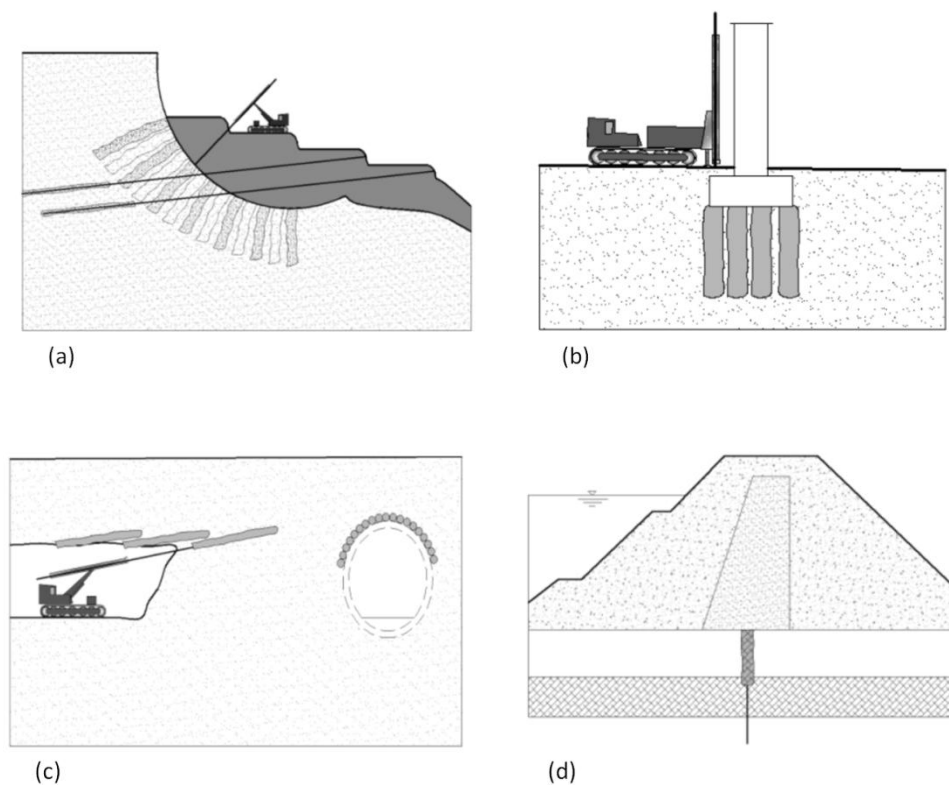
Utilização da técnica de jet grouting: (a) estabilização de taludes; (b) reforço de fundações; (c) aplicação sub-horizontal em reforço de túneis; (d) cortina impermeável em fundação de barragem. (Fonte: Roberto, 2012).
